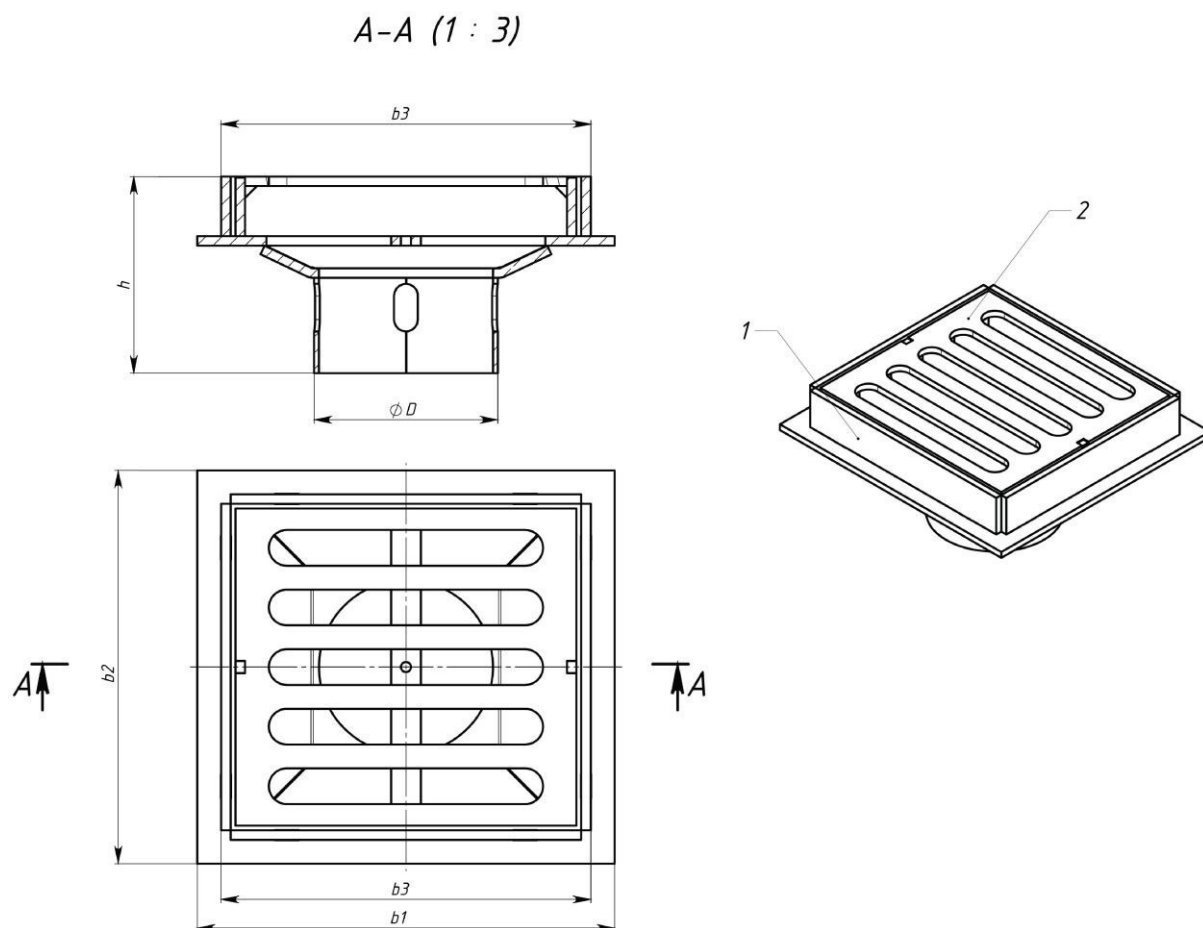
Общий вид универсального трапа-воронки для железобетонных и металлических пролетных строений.
